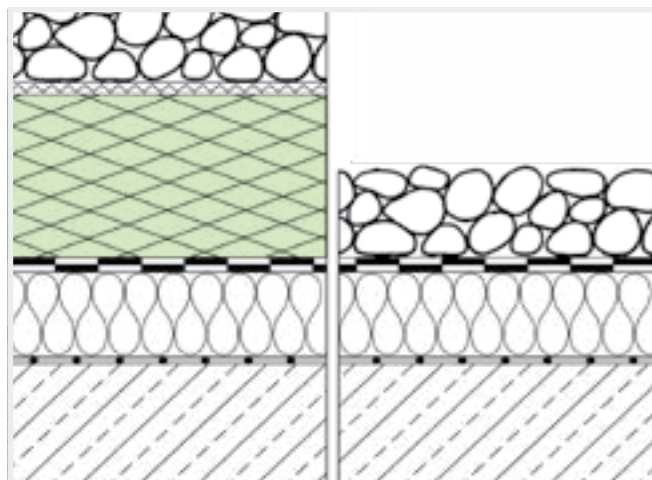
A sinistra nuova struttura di un tetto plus, a destra vecchia struttura del tetto caldo.
